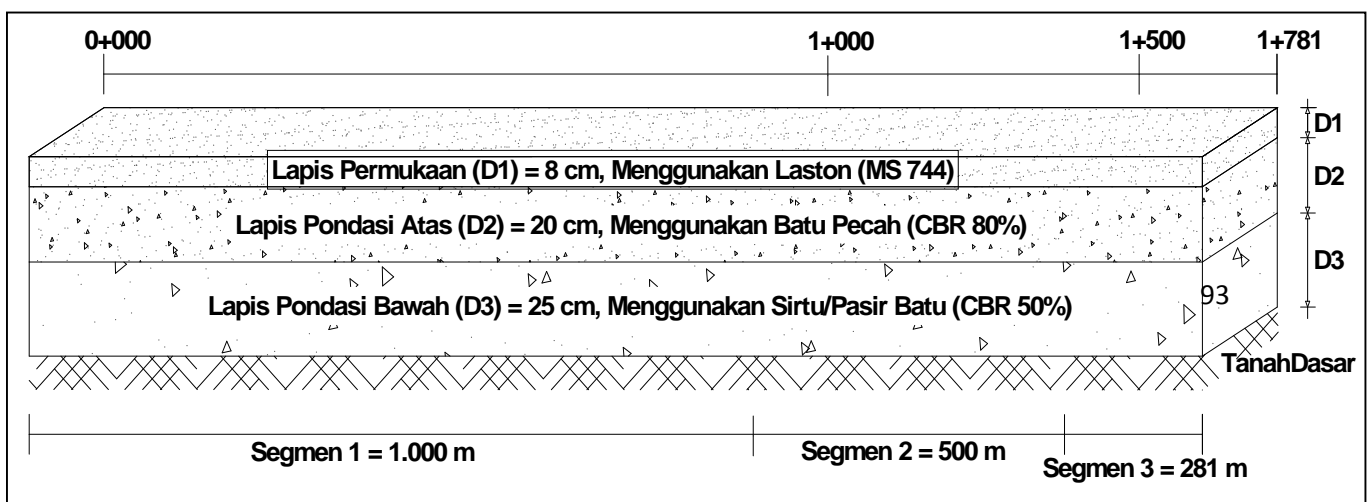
Lapisan Perkerasan Jalan Pada Segmen 3
